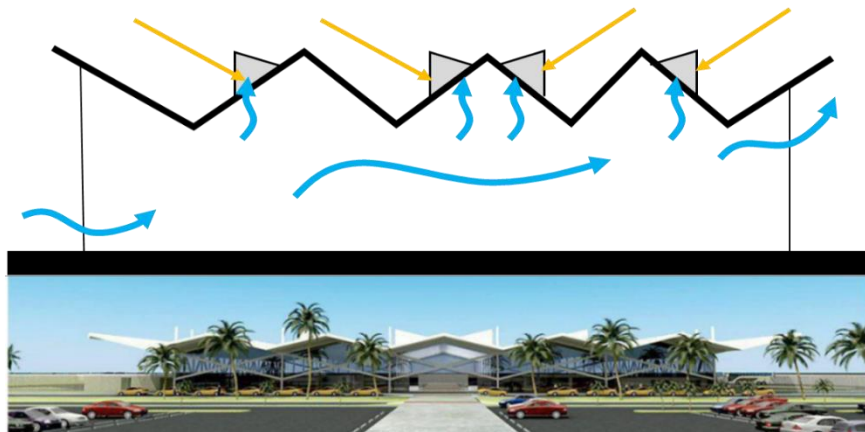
Corte transversal del Terminal Terrestre de Trujillo
